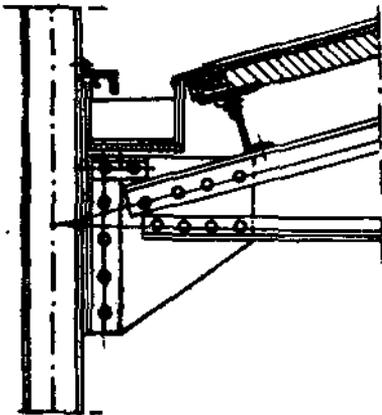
устройство желоба вдоль каменной стены. Кровля из пустотелых терракотовых или бетонных плит продолжена до самой
